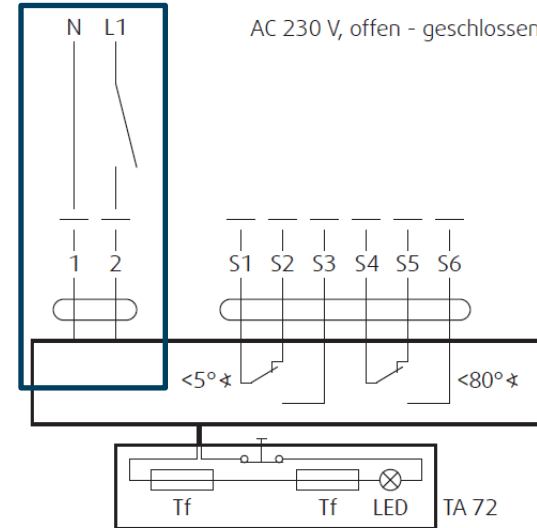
Anschlussschema G230T; Federrücklaufantriebe Gruner 340TA-230D-03-S2,
